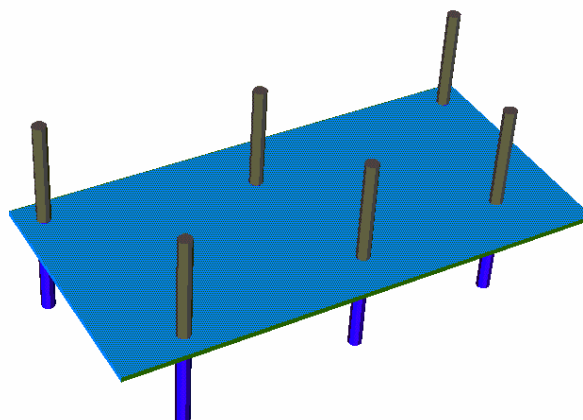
Vista Tridimensional da Estrutural do Exemplo 2
